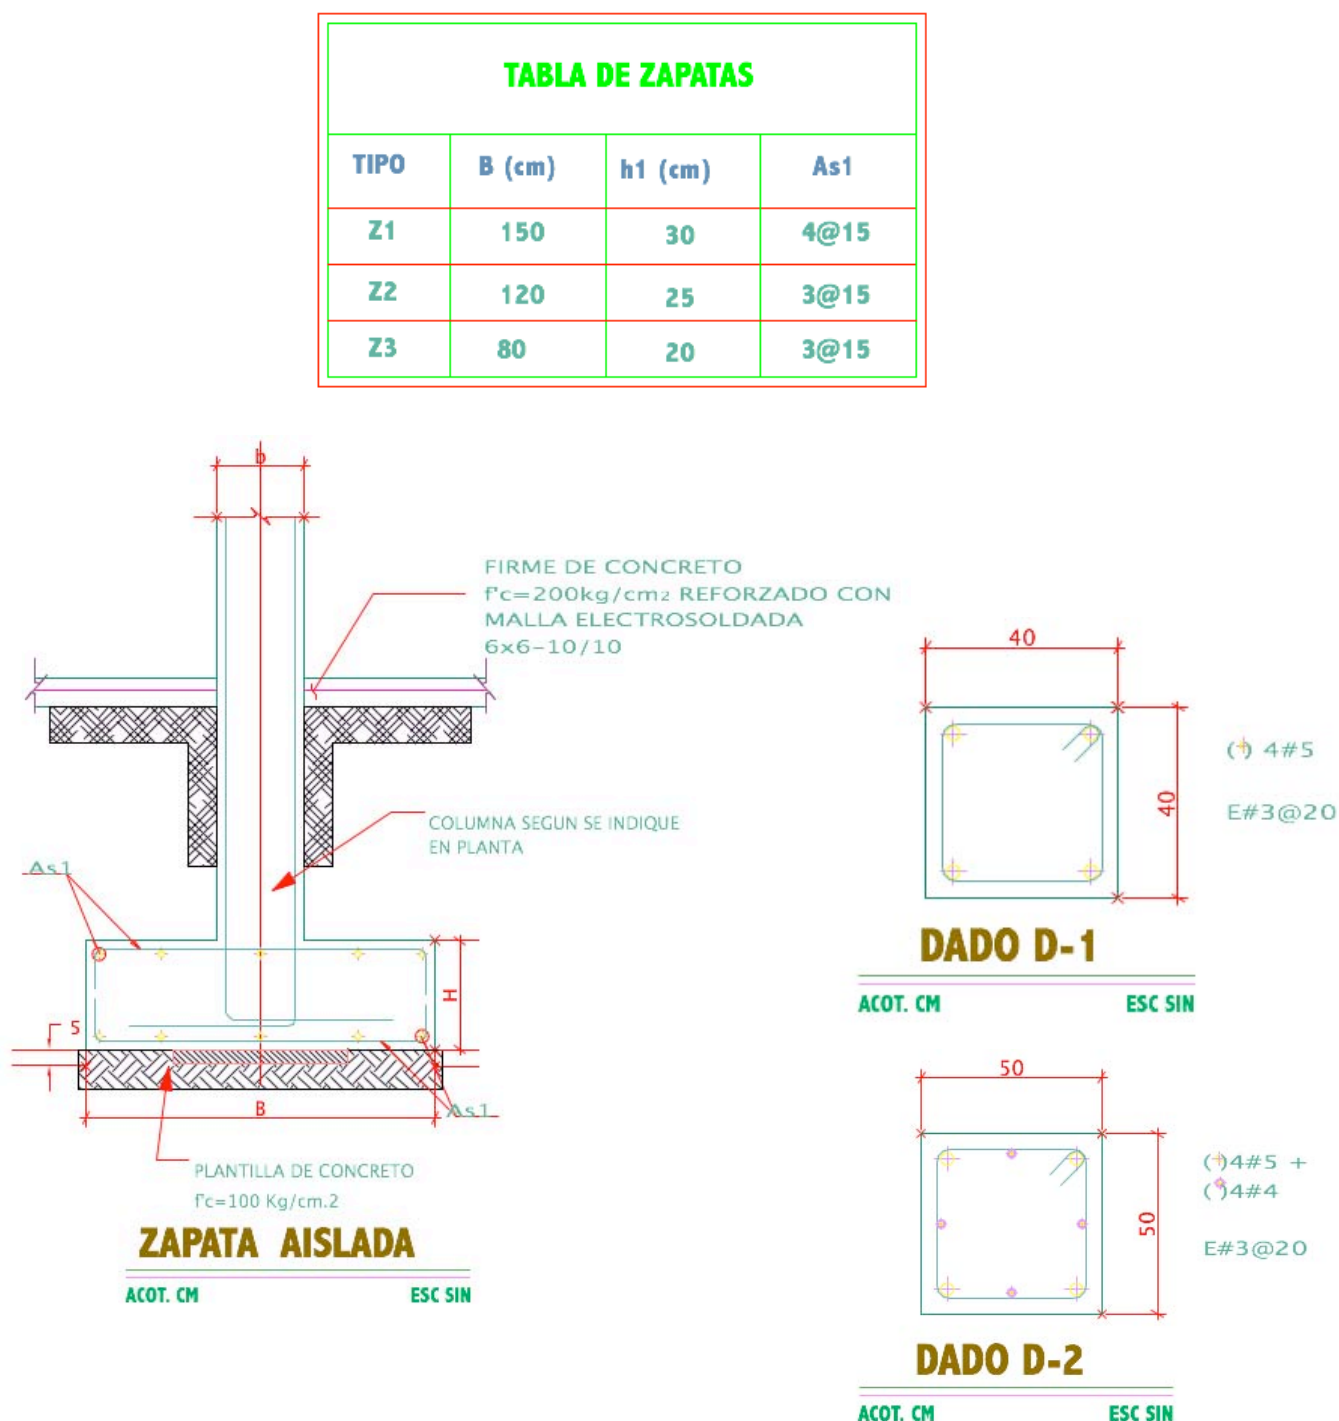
Detalle de Zapatas Aisladas y sus respectivos dados de cimentación
